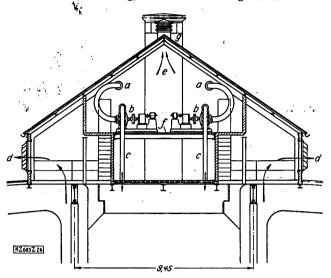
Oberlichtaufbau des Kesselhauses mit Entlüftung
